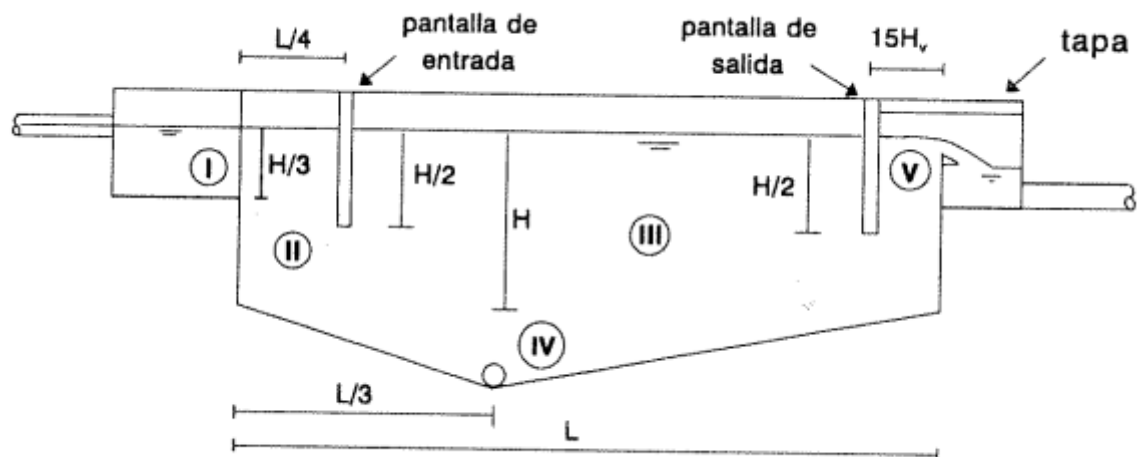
Alzado del desarenador. Fuente: (Cualla, 2000)
